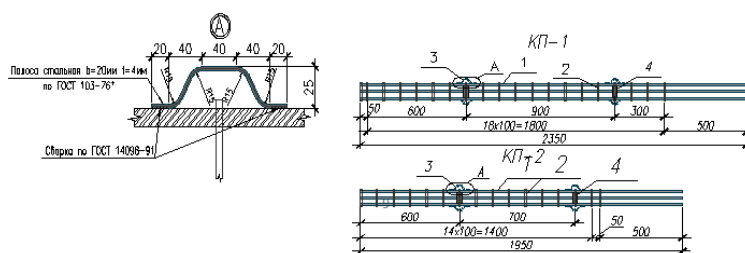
Армирование буроналивных свай: 1 – продольная арматура; 2 – поперечная арматура; 3 – фиксатор; 4 – элемент жесткости каркаса.
